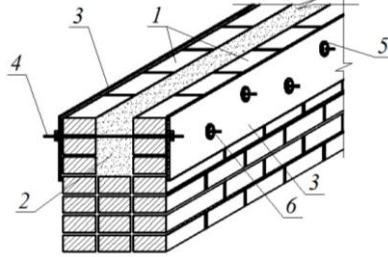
Принципова схема підсилення багатощарової цегляної кладки з використанням наскрізних анкерів: 1 – існуюча внутрішня і зовнішня поверхні цегляної кладки; 2 – бетонна суміш; 3 – опалубні поверхні; 4 – арматурні стрижні-анкери; 5 – запобіжна гайка; 6 – фіксуюча гайка.
